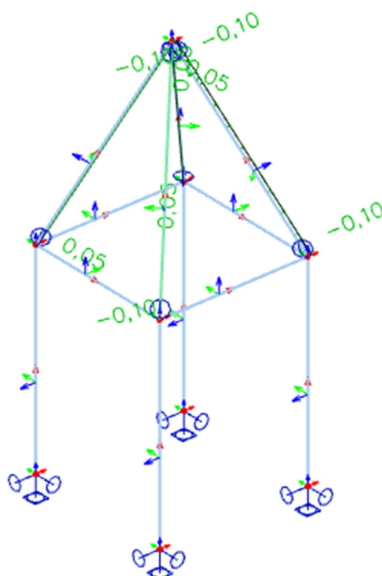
Konstrukce 1b, Zatěžovací stav ZS4
